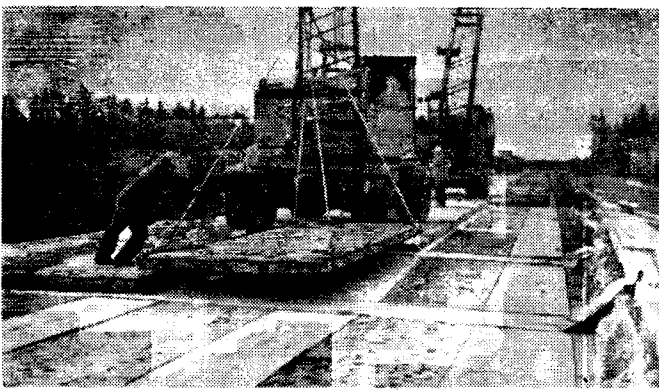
Укладка плит ПАГ-14 на прослойку из нетканого материала, уложенного под продольными и поперечными швами покрытия
